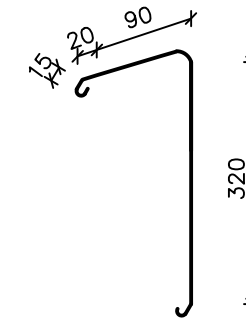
STŘEŠNÍ KONSTRUKCE
